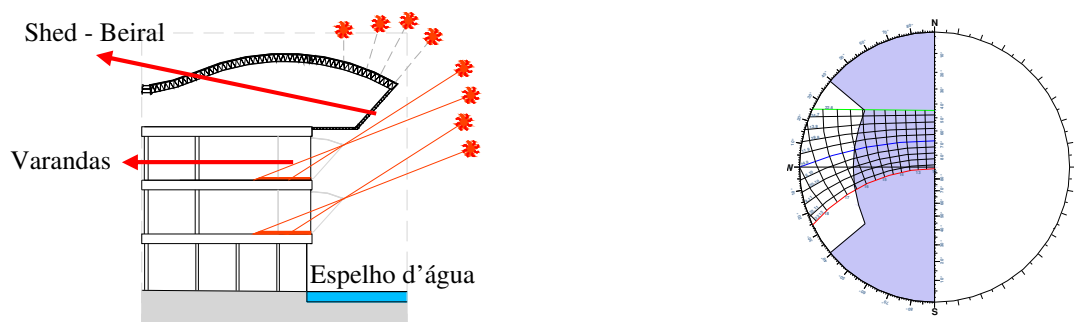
Estudo da insolação na fachada oeste – apartamento individuais e máscara de sombra, respectivamente
